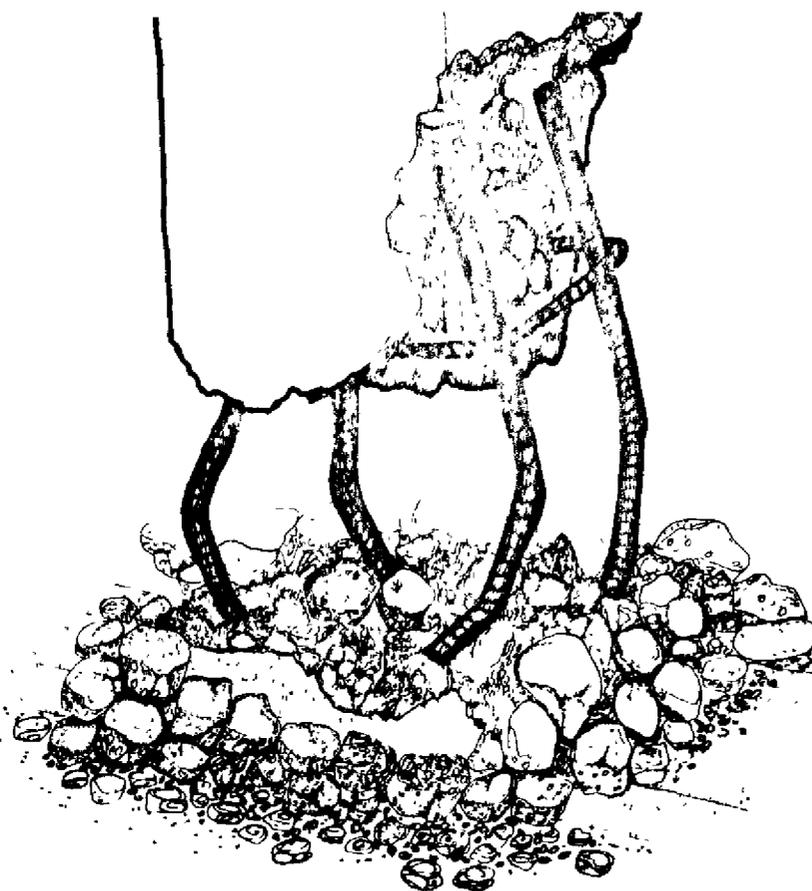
Falta de estribos de confinamiento en la parte inferior de las columnas
